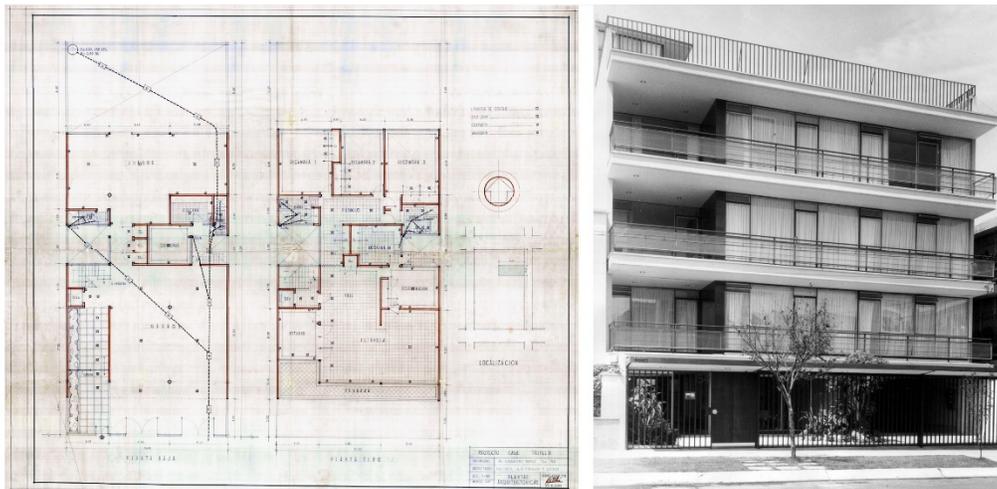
Plano de proyecto de la planta baja y tipo, 1955 y vista del edificio ubicado en Alejandro Dumas núm.154, 1957. Se observa en la fotografía de la fachada los barandales recubiertos con mampáras de acrílico color naranja, acentuando la horizontalidad.
